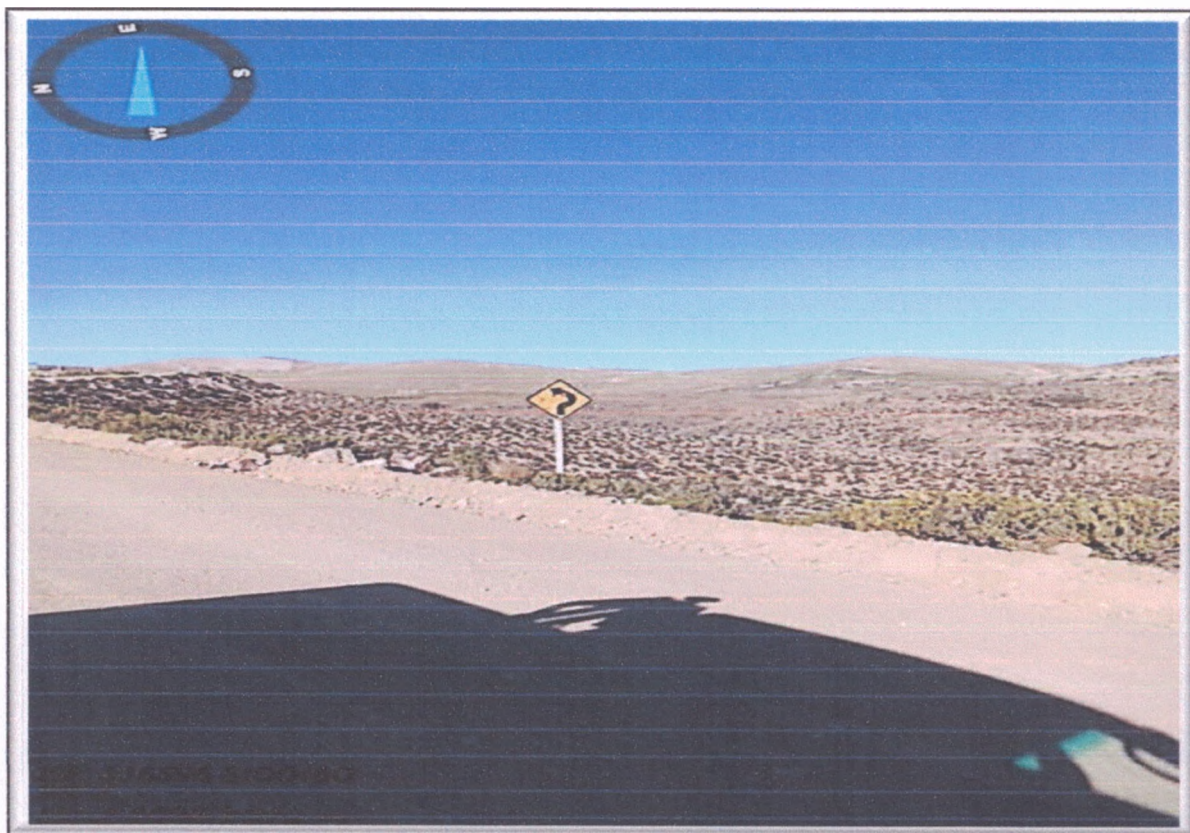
Vista señal Preventiva en mal estado M.D.
